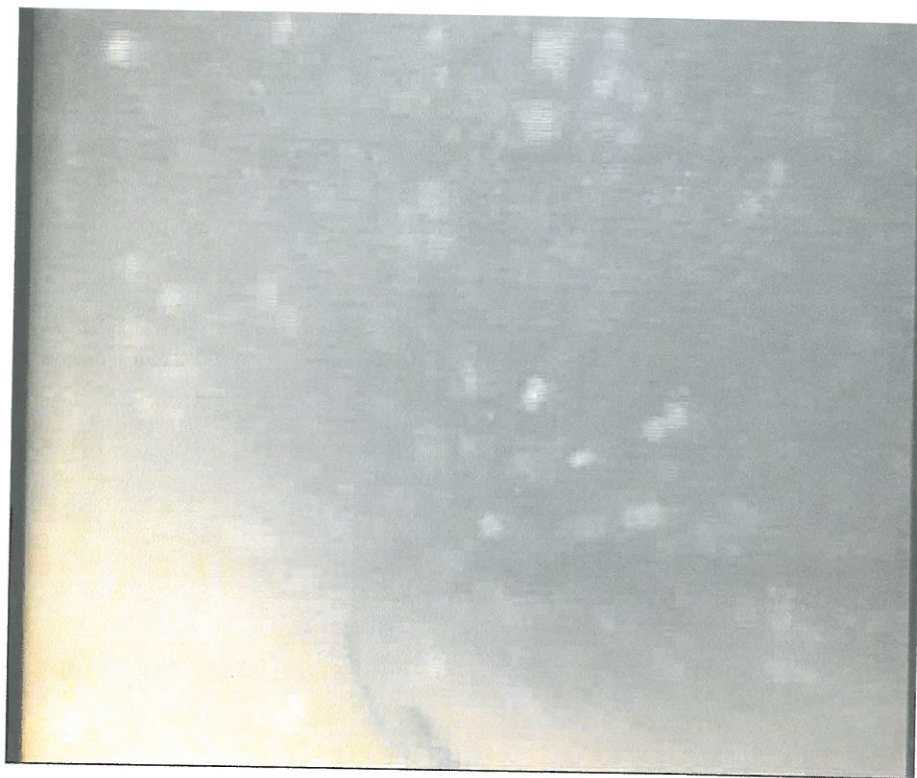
Widok rury nadfiltrowej - głębokość 6 m.
